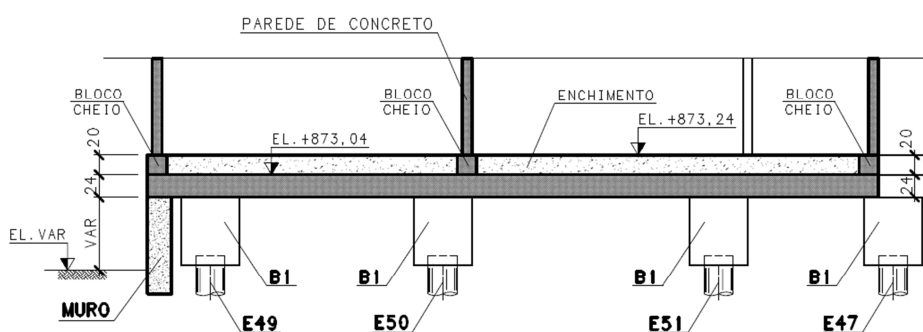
Fundação em Laje Estaqueada (modelo adotado neste trabalho)
